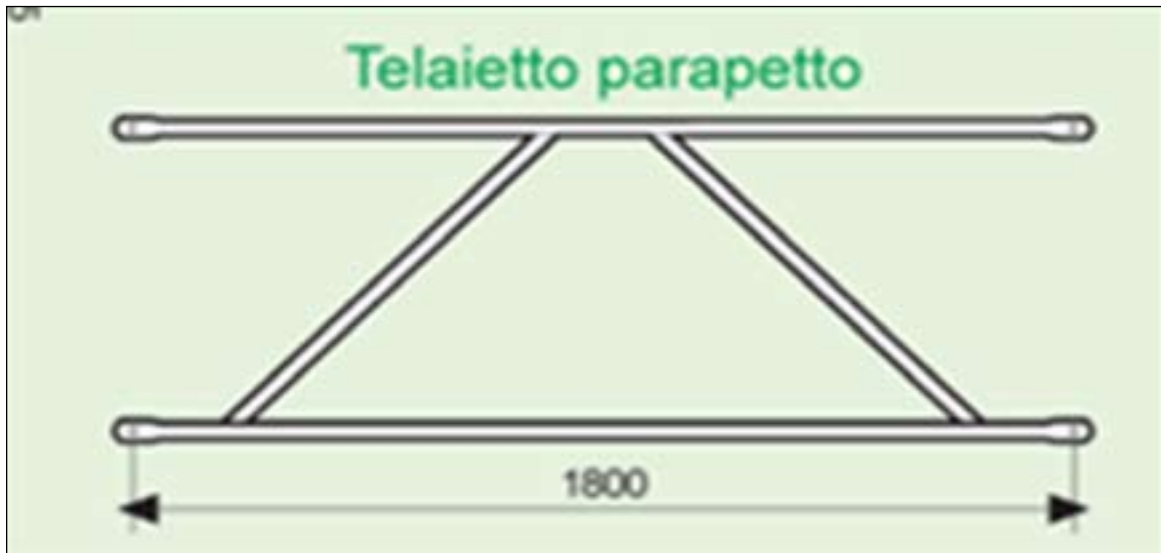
Telaio parapetto prefabbricato: è anche irrigidimento nel piano verticale
